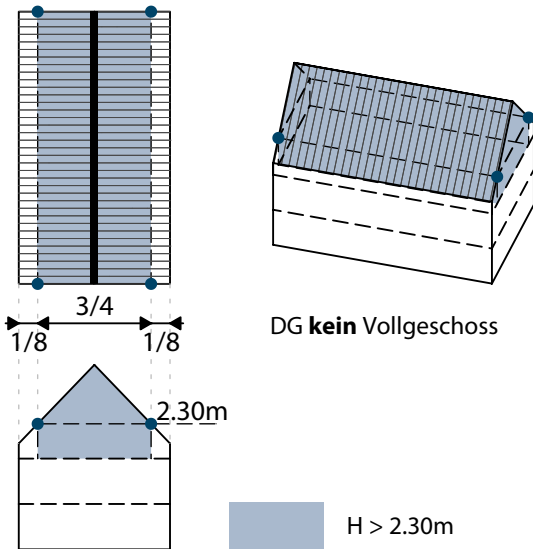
Beispiel Dachgeschoss kein Vollgeschoss
